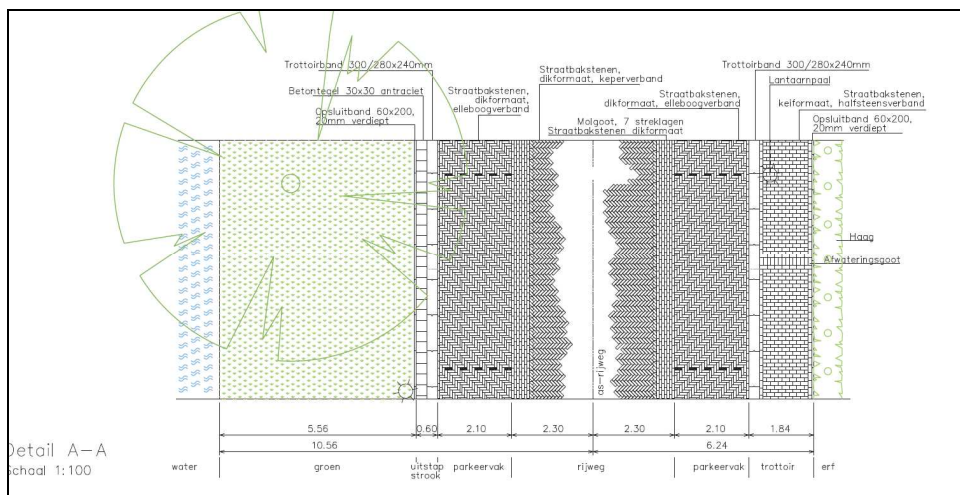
Profiel hoofdplanstructuur met één rijbaan
